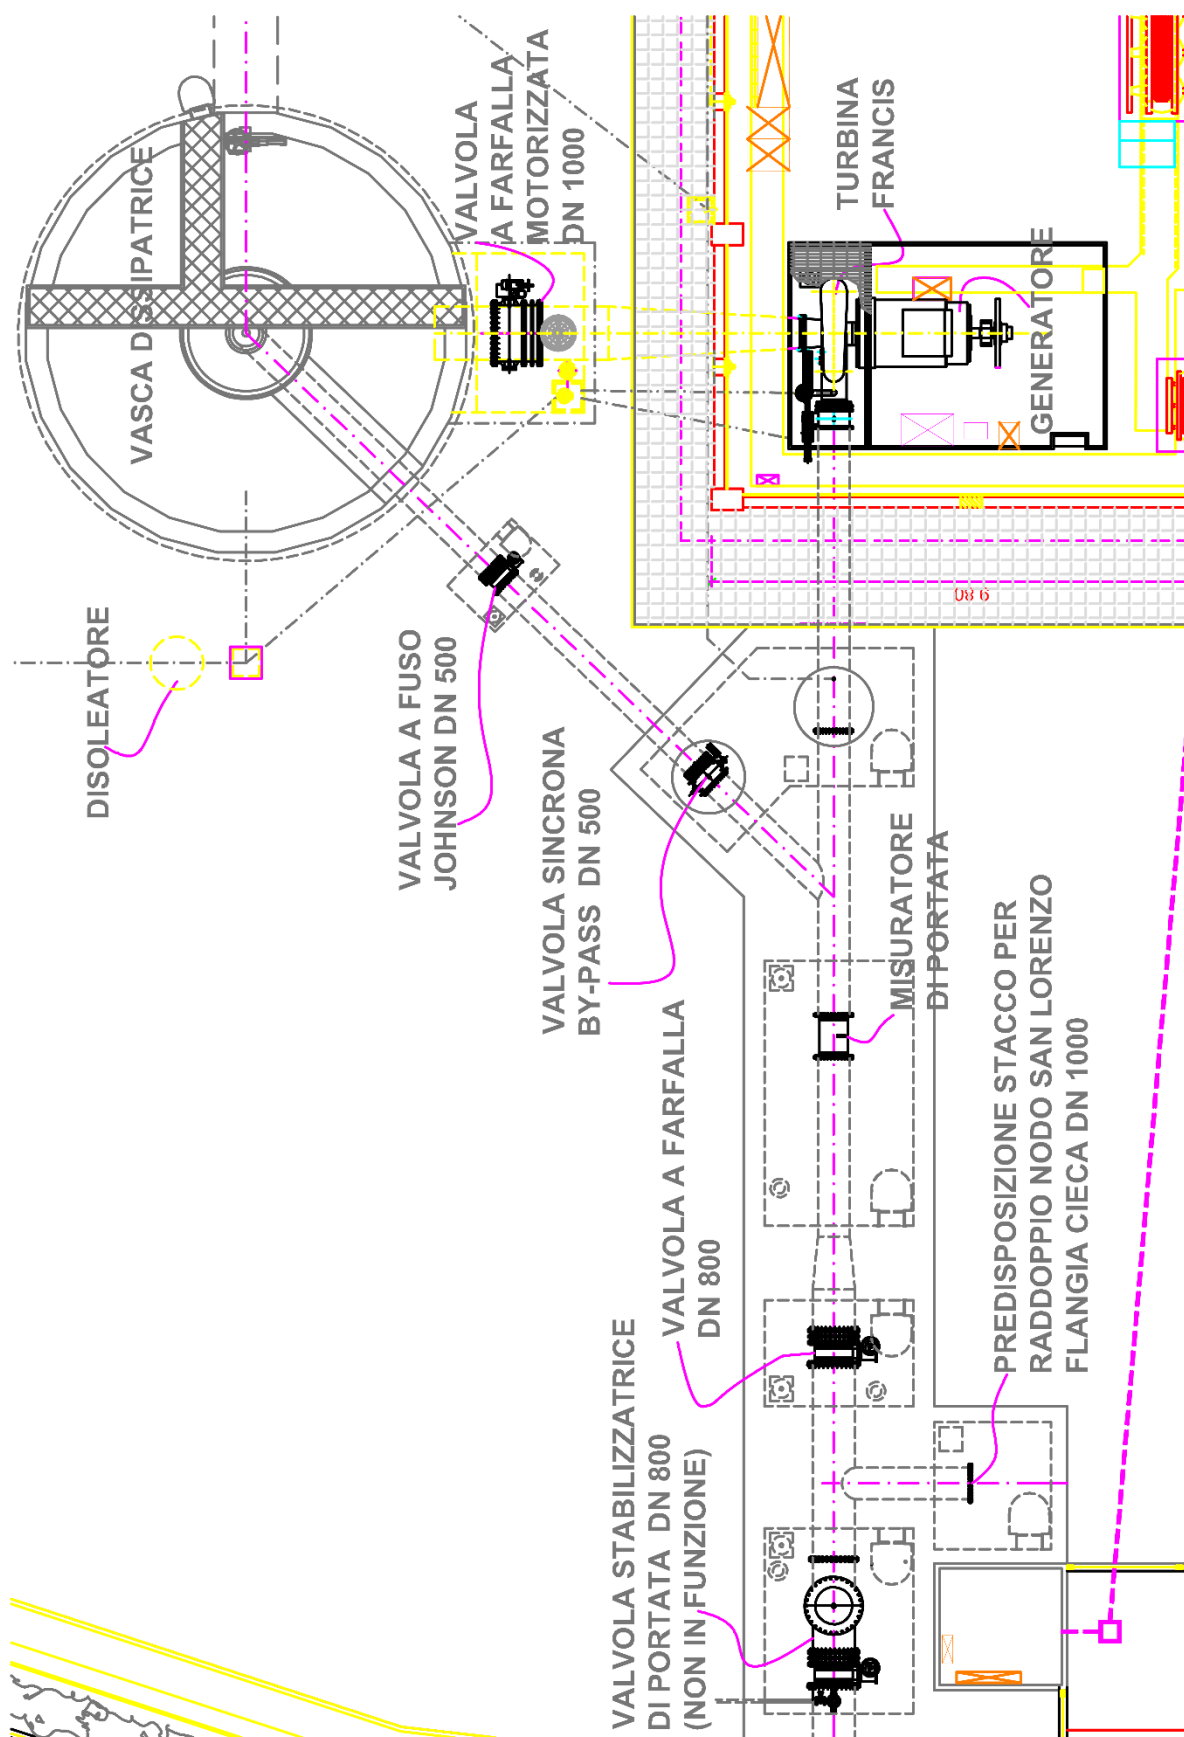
Stralcio planimetria opere di arrivo centrale idroelettrica di San Lorenzo.
